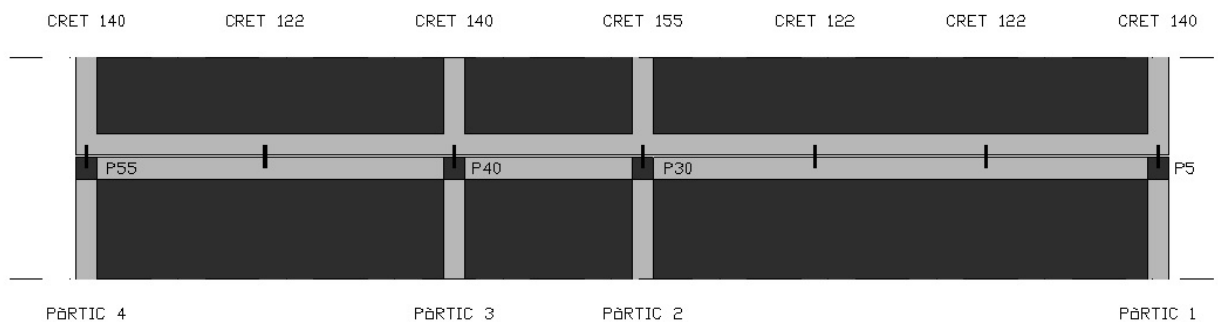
disposició de passadors tipus Cret Goujon al Sostre de la planta soterrani.
